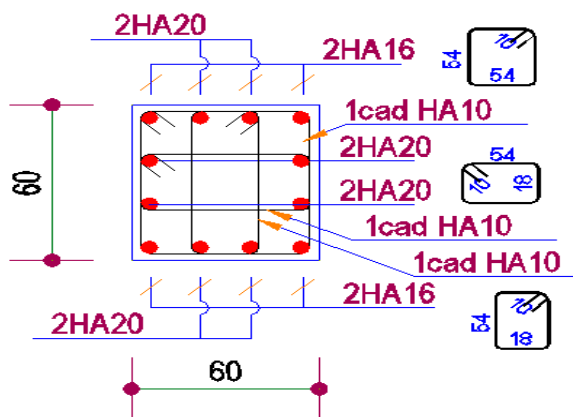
Schéma de ferrailage des poteaux du 2^{ème} et 3^{ème} étage
